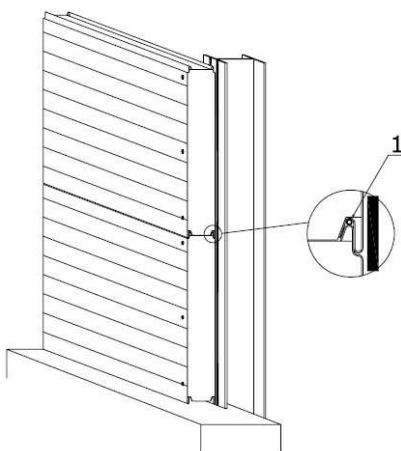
Установка уплотнителя. 1 – трубчатый уплотнитель (герметик)
